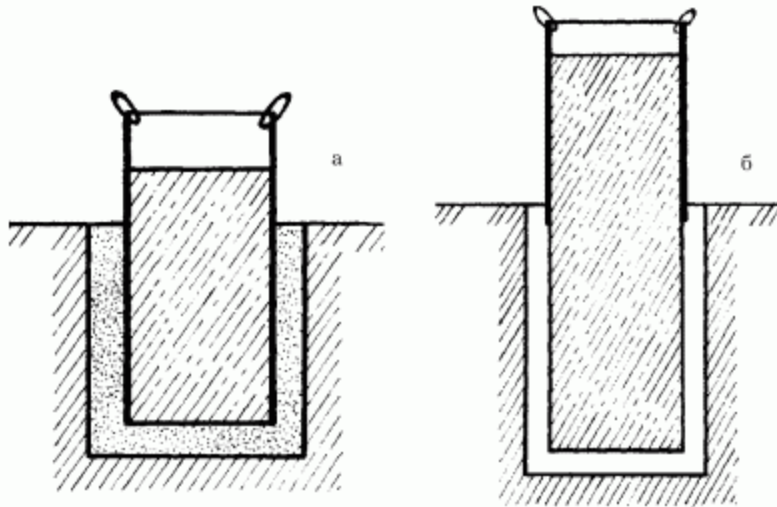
Устройство столбчатого фундамента в трубе-опалубке: а – изготовление нижней части бетонного столба; б – изготовление верхней части фундаментного столба.
